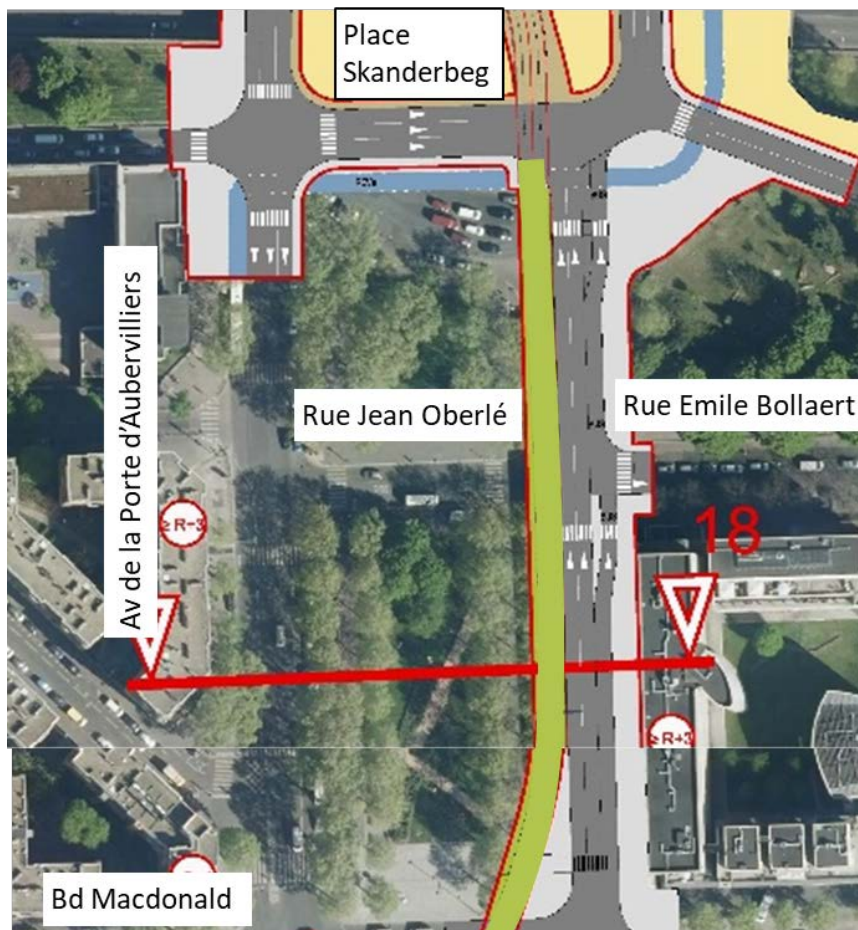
Tracé de l'OPTION 1 du tram dans l'avenue de la Porte d'Aubervilliers
